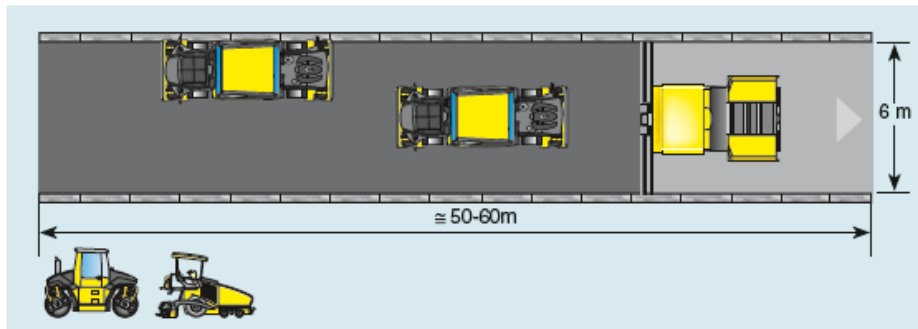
Distribuição dos equipamentos de compactação para uma pavimentadora utilizando uma mesa de pavimentação com 6 metros de largura
